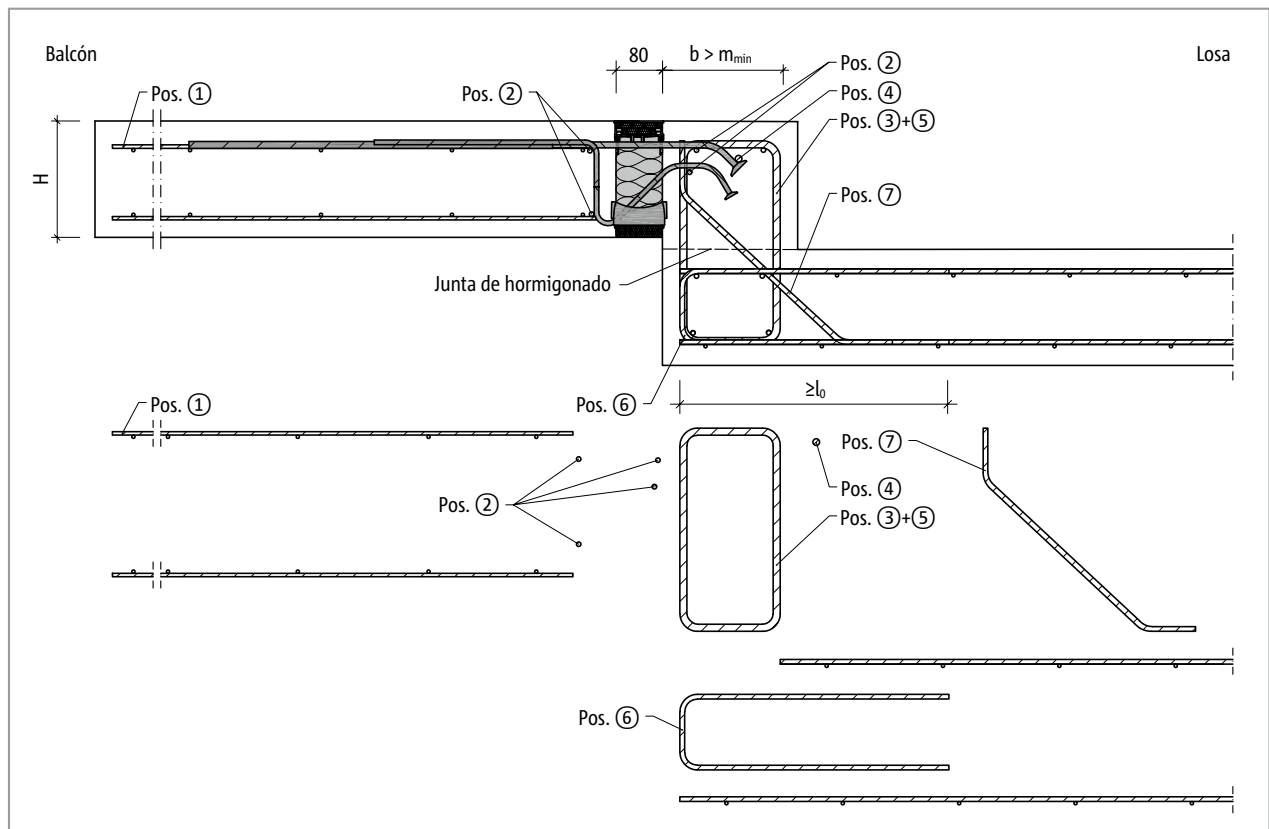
Schöck Isokorb® T tipo K-O-F: Armadura in situ para balcón con desplazamiento de altura hacia arriba con dimensión mayor del elemento constructivo ($m_{\text{exist}} > m_{\text{min}}$)
